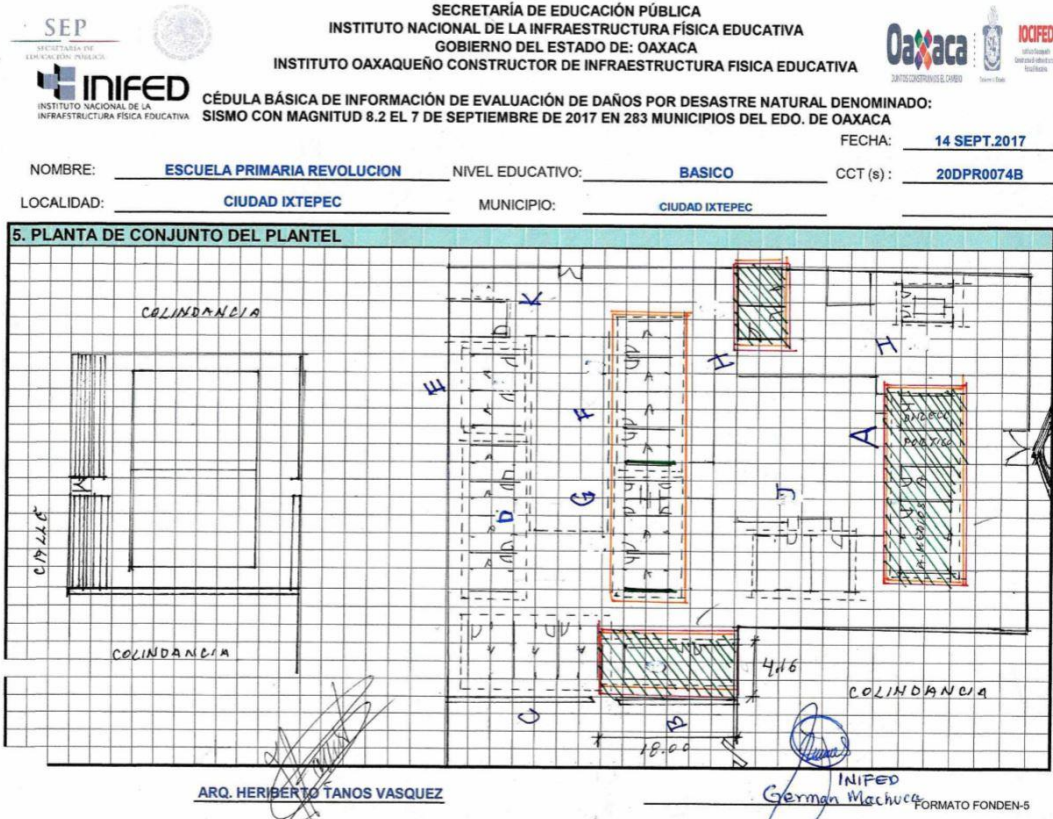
Planta de conjunto del plantel en la cédula INIFED.
